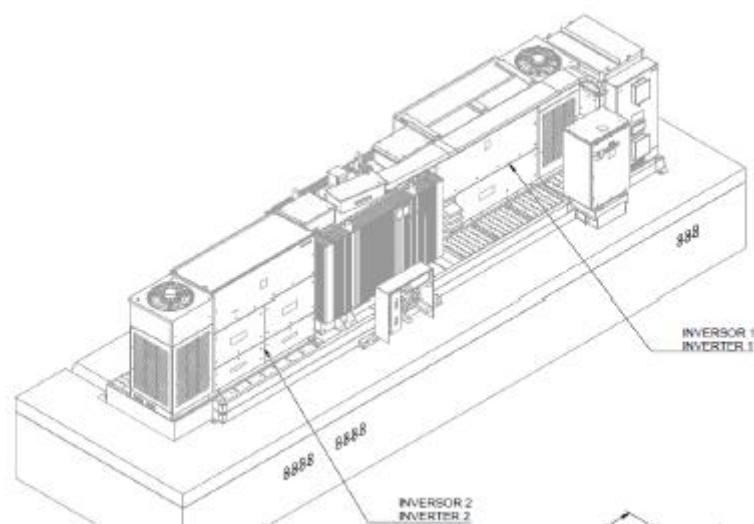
b. Power Block proyecto reformado (2 inversores). Fuente: Reformado de proyecto de planta solar fotovoltaica "FV Salinas II 49,5 MWp".
